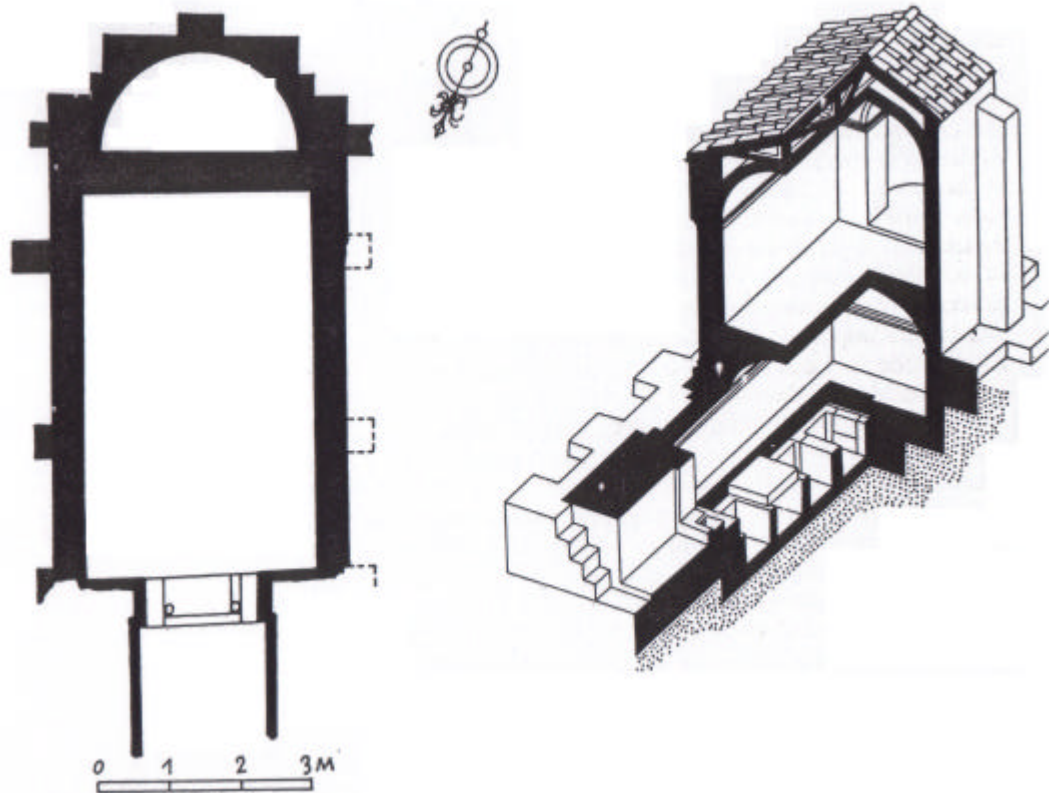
La Alberca (Murcia). Planta del mausoleo a nivel de suelo y alzado de la cripta subterránea y capilla superior (reconstrucción) (Fontaine, 1973, 85, según Schlunk y Mergelina)
